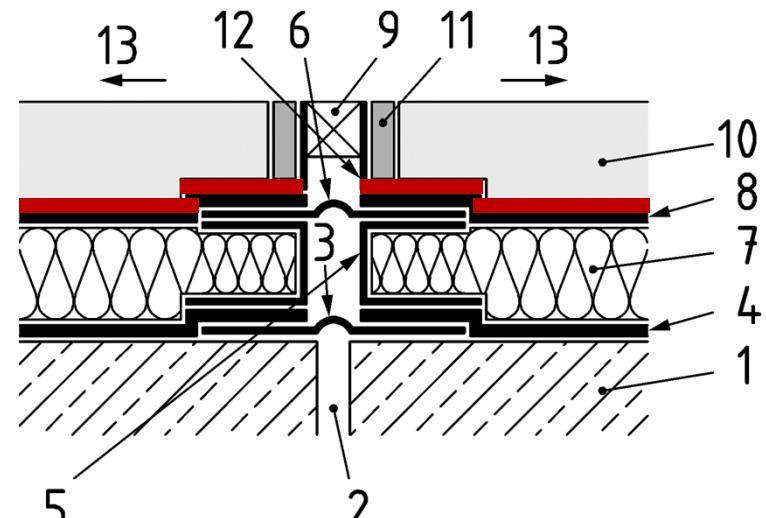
Abdichtung einer Bewegungsfuge bei Bauweise 2b
